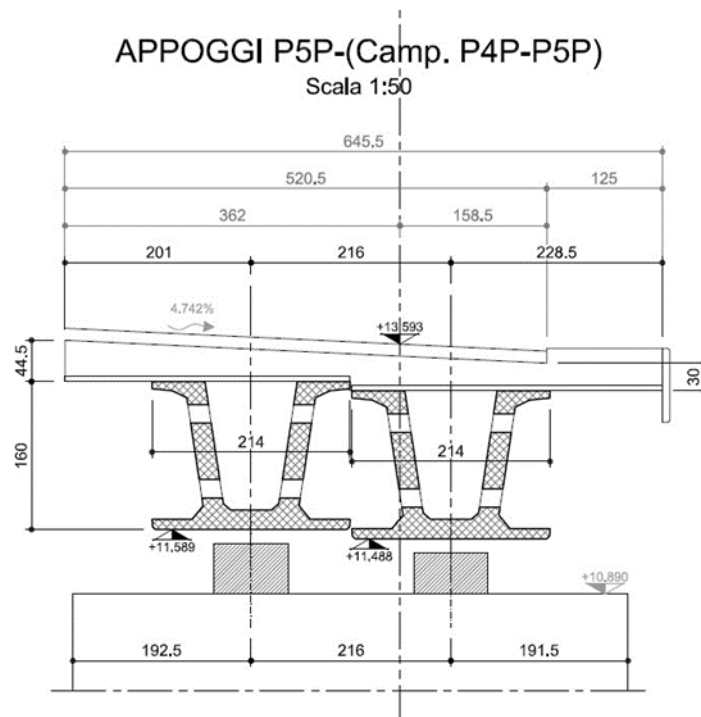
Sezione trasversale Campata 5 (a 2 travi) – Rampa P – P5_P
